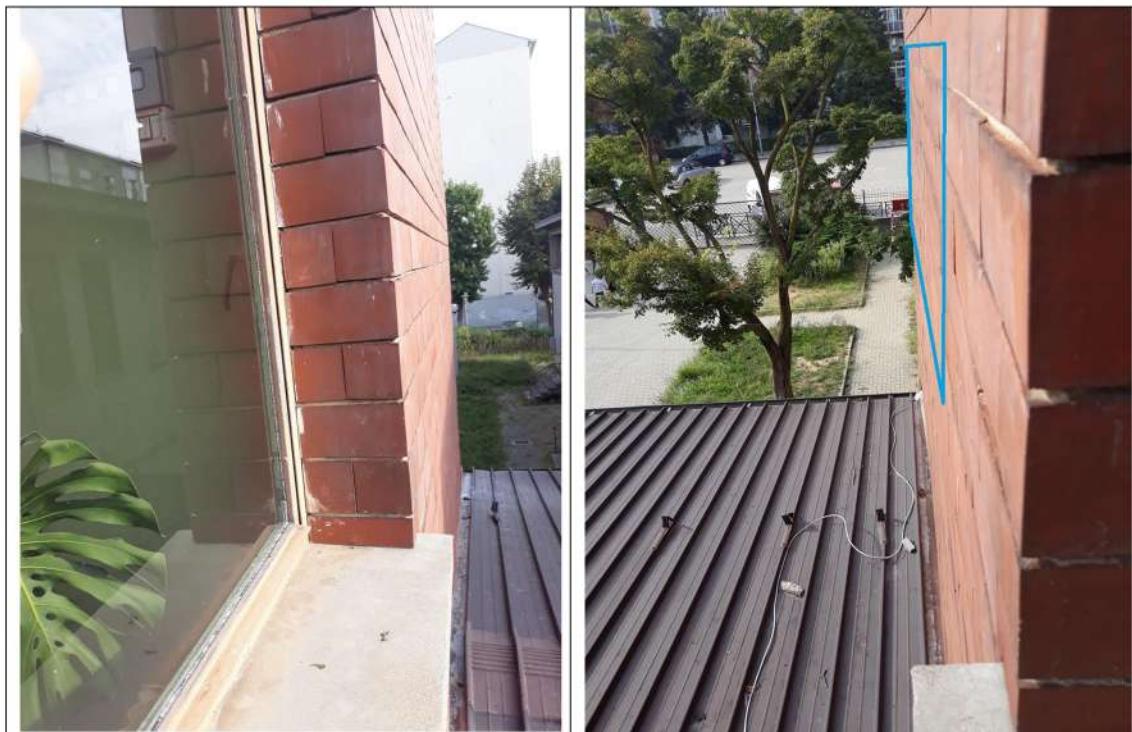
I.C. “G. Salvemini”: passaggio cavi e parete installazione centralina
